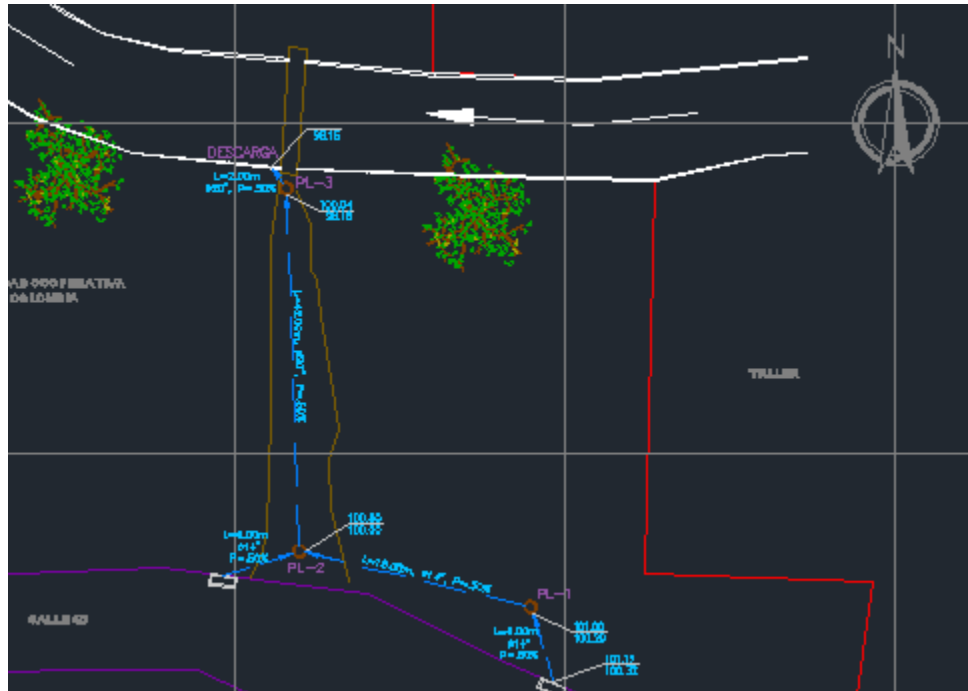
Captura plano Autocad vista en planta de los diseños constructivos. Barrio Floresta Baja
